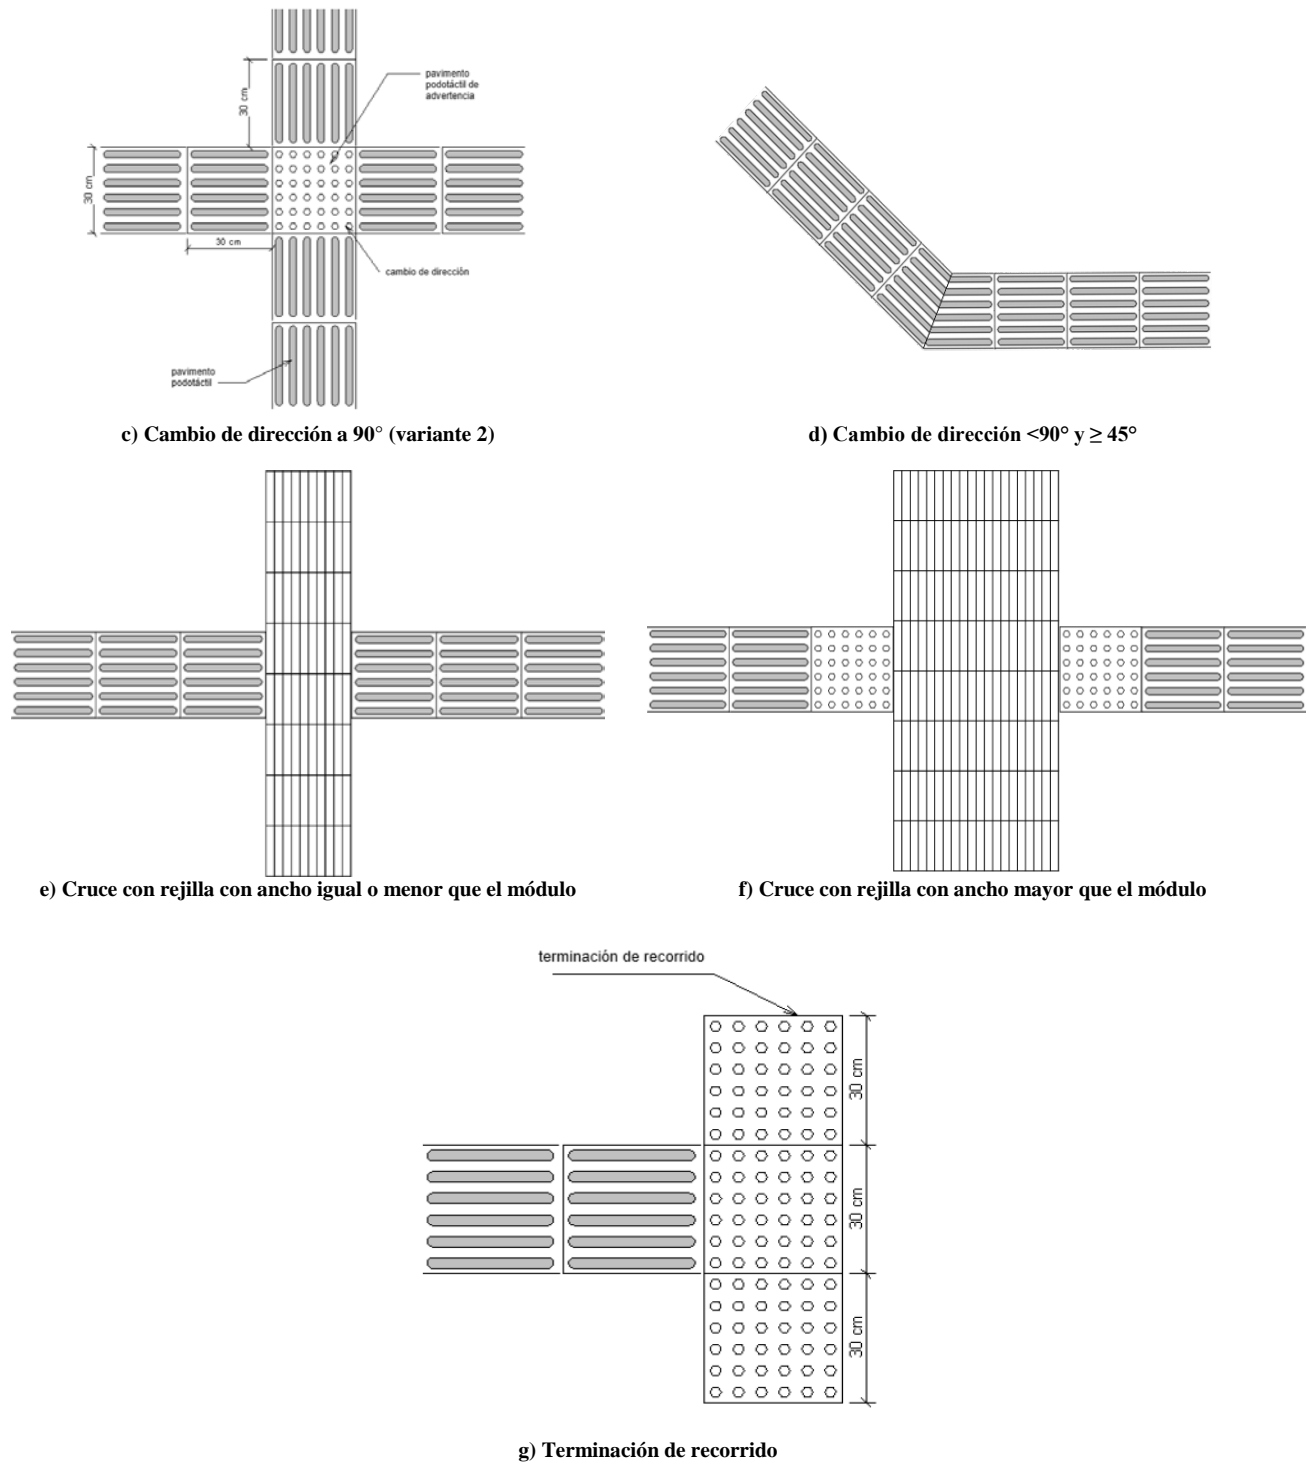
Ruta con pavimento táctil
